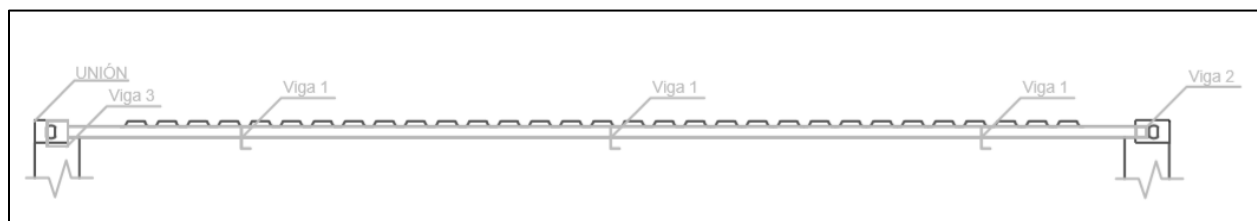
Planta de vigas estructurales en cubierta. Elaboración propia
